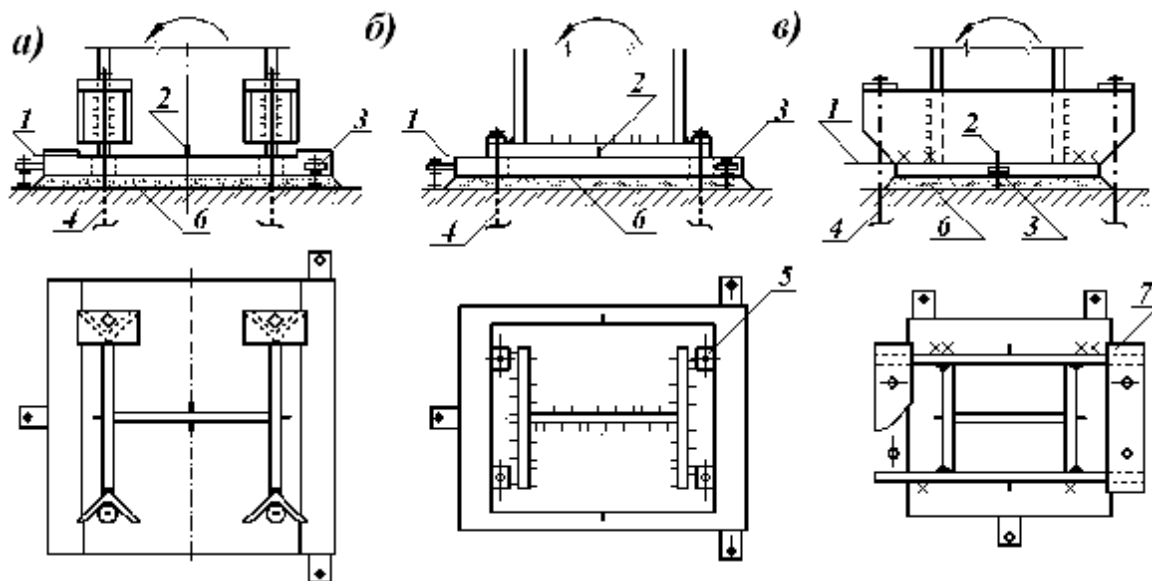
Базы колонн при больших изгибающих моментах. 1- плоскость фрезерования; 2- установочная риска; 3- установочный болт; 4- анкерный болт; 5- шайба; 6- подливка; 7- анкерная плитка.
